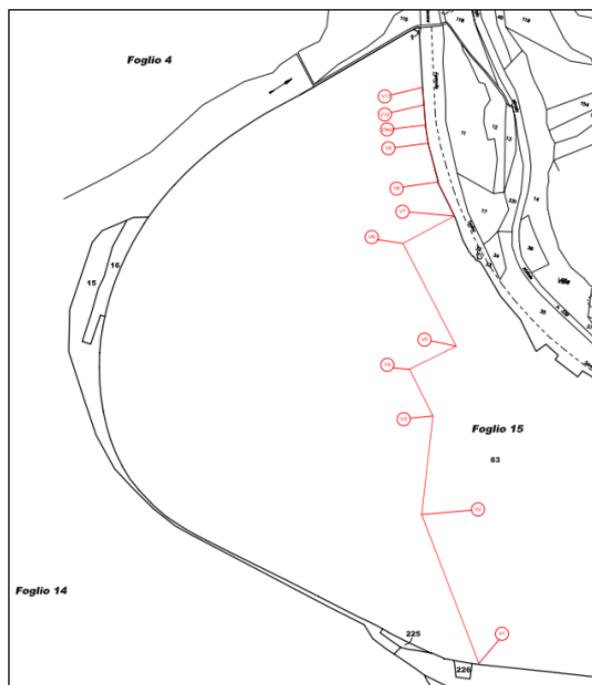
Setto di separazione A1/A2 (fonte: Progetto Esecutivo del setto di separazione Zone A1 e A2 –Tav. 03-01-BL-A-94439 – Snamprogetti)
